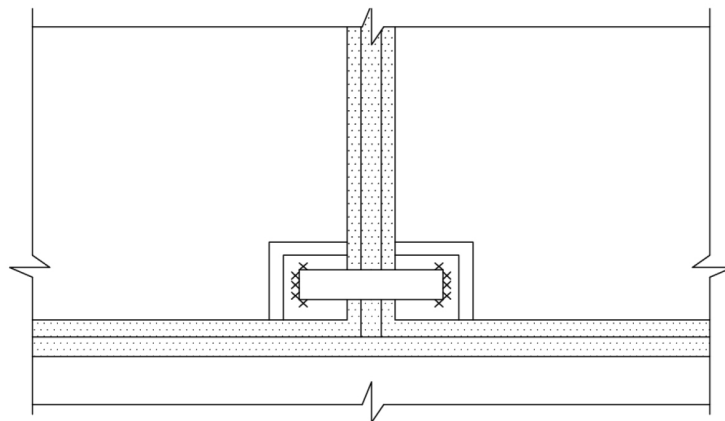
, начало. Стык наружных стеновых панелей с плитами перекрытия
